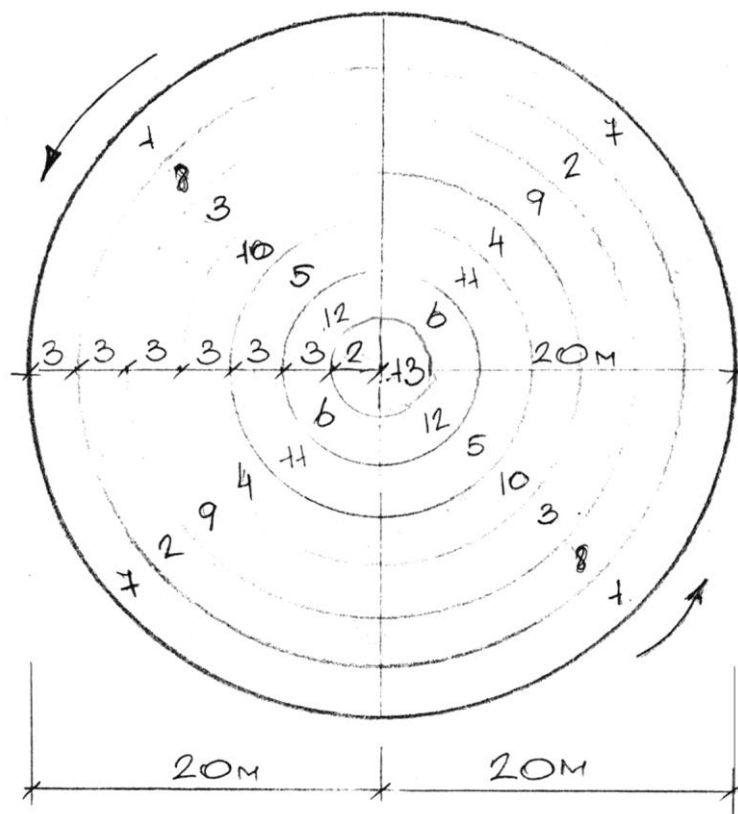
Послідовність укладки першого шару бетону в днище діаметром 40м.
